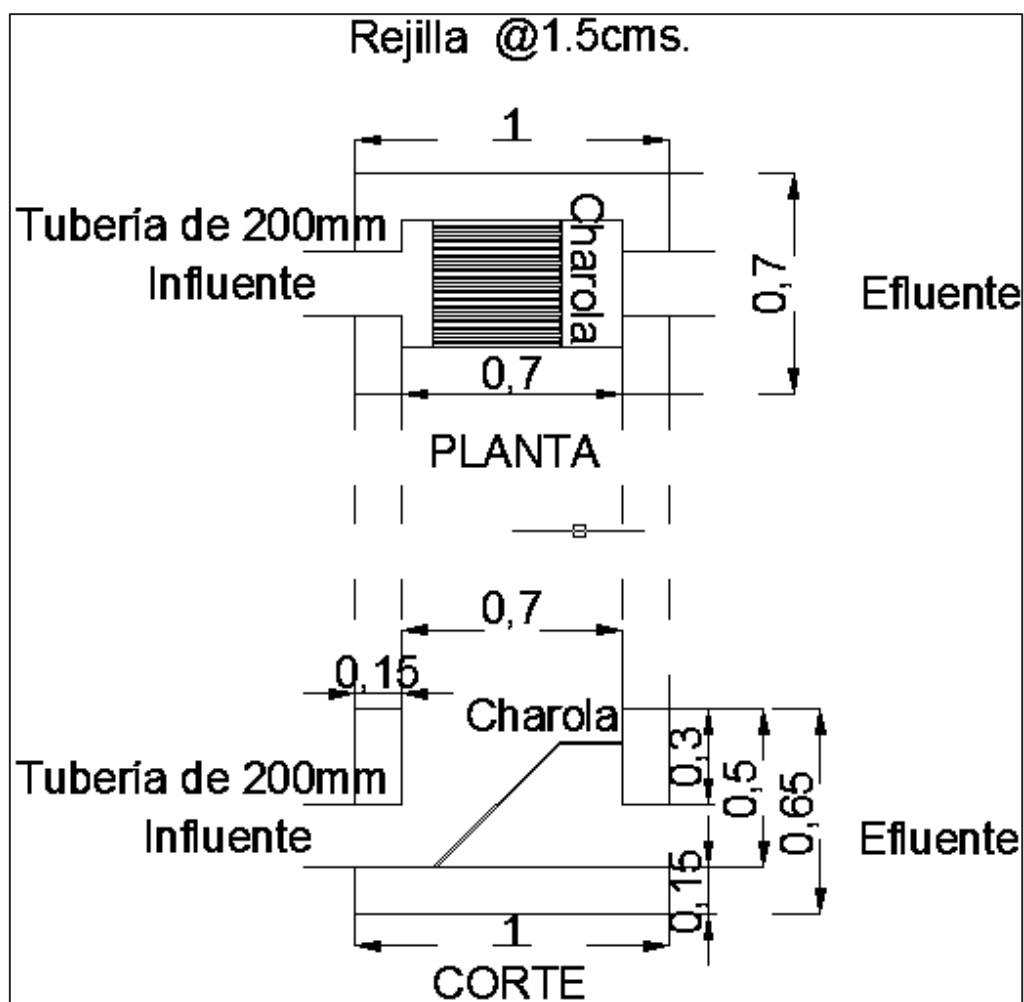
3 Vistas en planta y corte transversal de la rejilla
